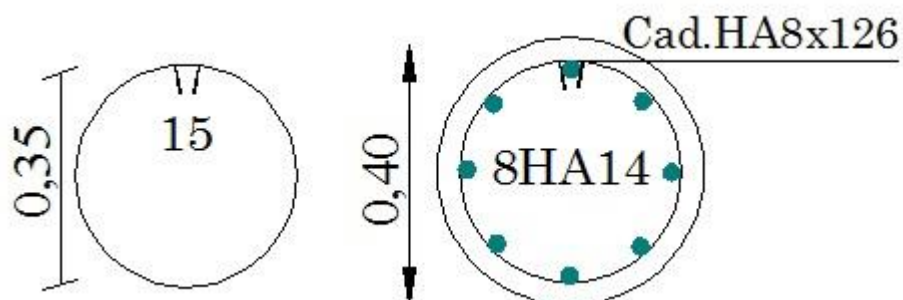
Coupe de ferrailage des poteaux cercle.
